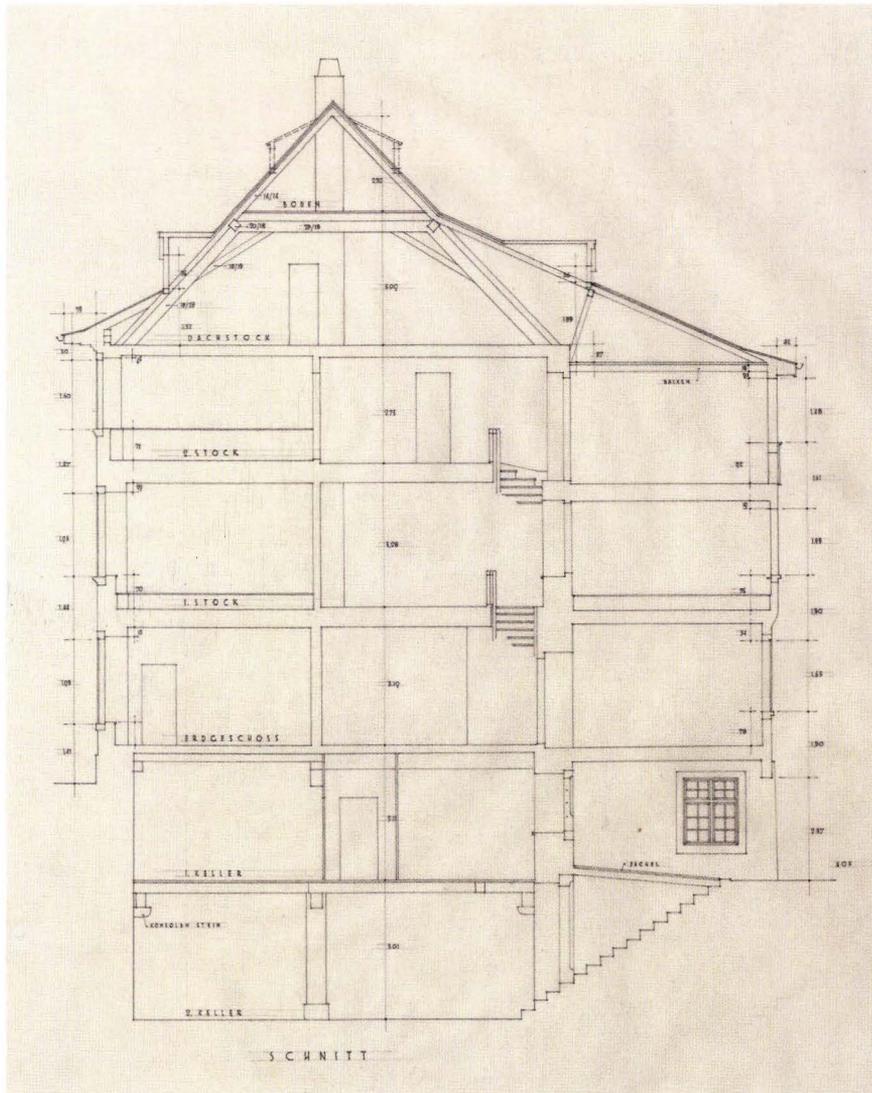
Spalenvorstadt 10. Querschnitt durch Haus und Hofanbau. Das strassenseitig (links) drei- und hofseitig viergeschossige Gebäude besitzt zwei Kellergeschosse, wovon das obere zum Hof hin ebenerdig liegt. An dieser Seite entstand der Fachwerkvorbau mit urspr. offenem Untergeschoss und zwei Geschossen darüber. Das oberste Geschoss ist eine Aufstockung mit angeschleppter Bedachung. – Plan: Altstadttaufnahmen, Zentrale Arbeitsbeschaffungsstelle, Baudepartement Basel-Stadt, 1941.
